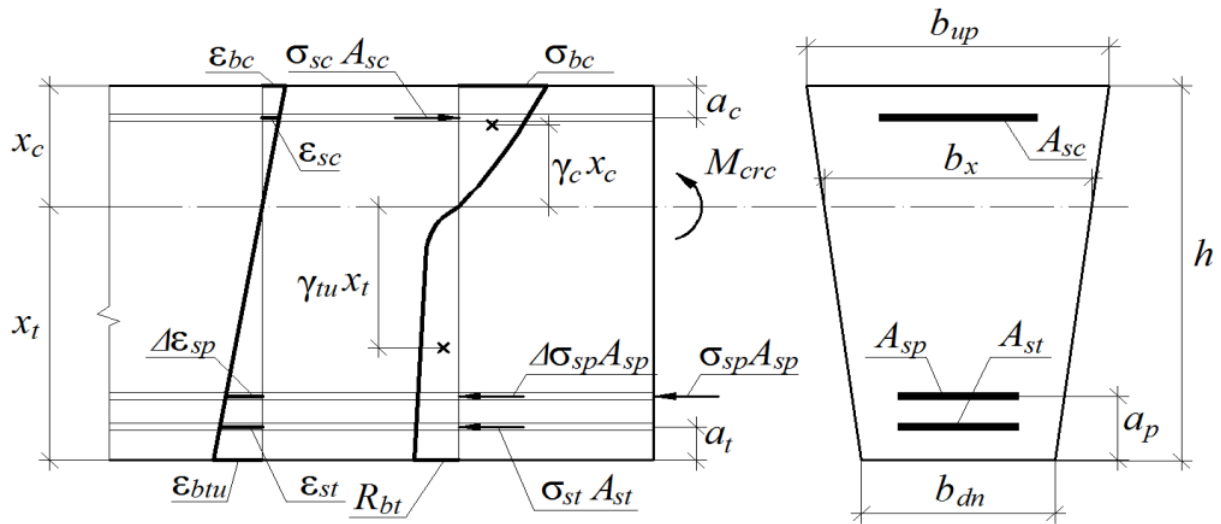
Расчетная схема железобетонной балки трапециевидного сечения с предварительно напряженной арматурой в растянутой зоне для начальной стадии процесса трещинообразования
